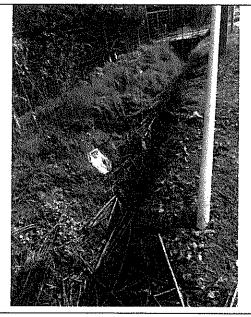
Alcantarilla sin su sección libre en un 90%, kilómetro 15, camino rol G-18. (20-08-2013)
